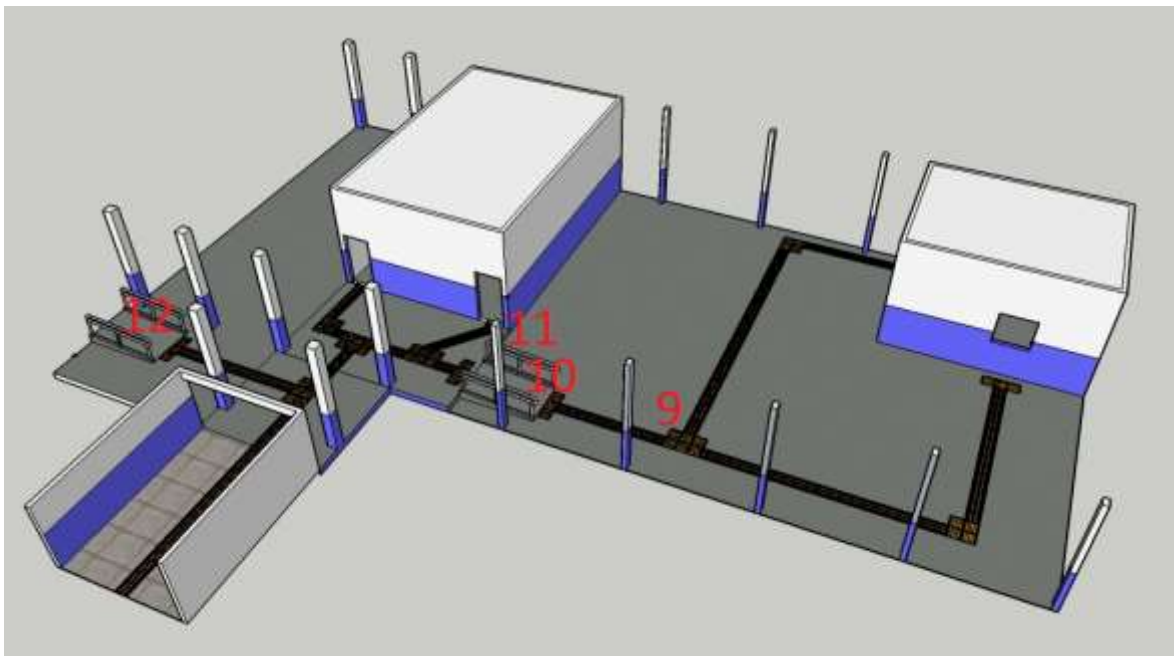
Vista da área externa da escola. Ao centro da foto estão as instalações sanitárias de uso coletivo.
